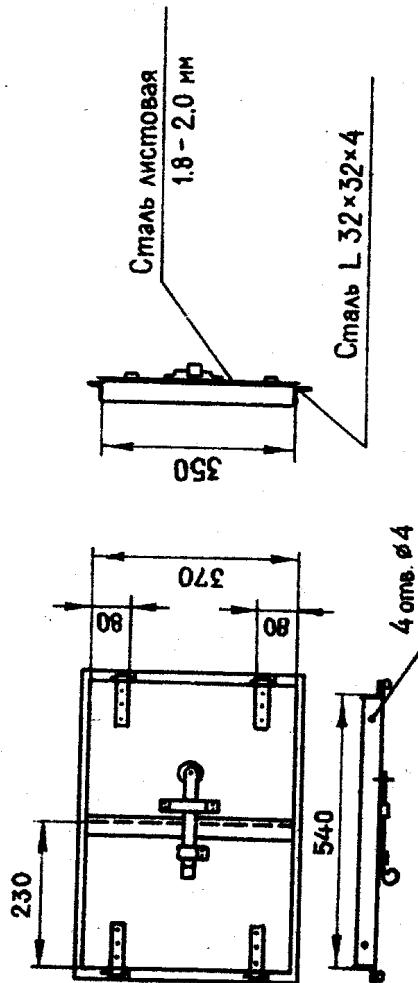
Рамка с дверкой для варочной камеры печи III-5
